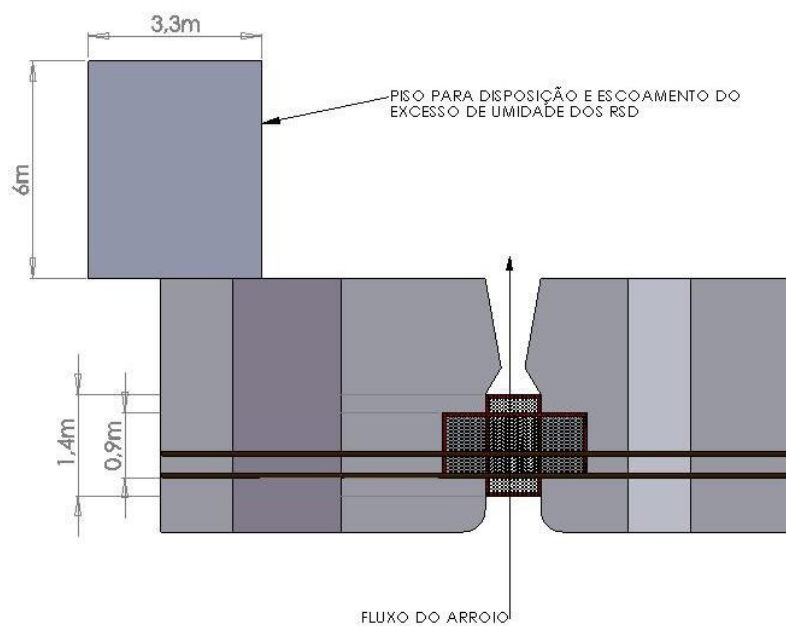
Armadilha utilizada para captação de RSD em vista superior.
